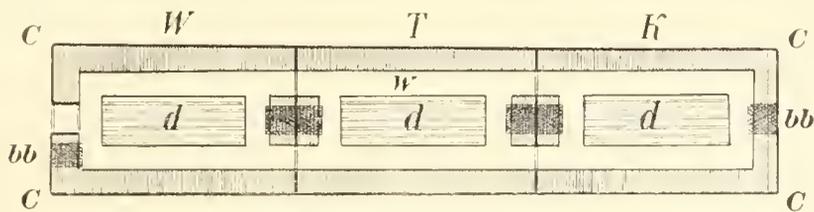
Grundriss eines Orchideenhauses. (*W* warme, *T* gemässigte, *K* kalte Abtl.)
